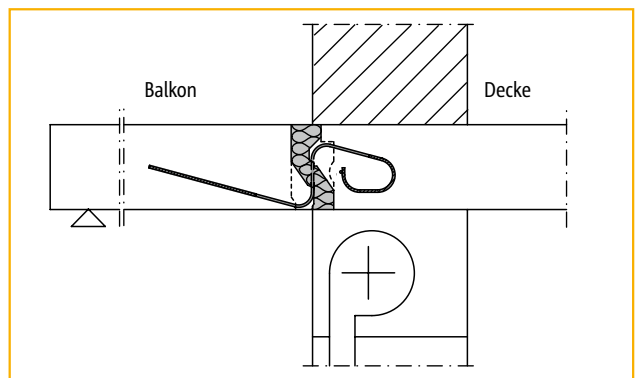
Einschaliges Mauerwerk mit Rolladenkasten bei deckengleichem Balkon
